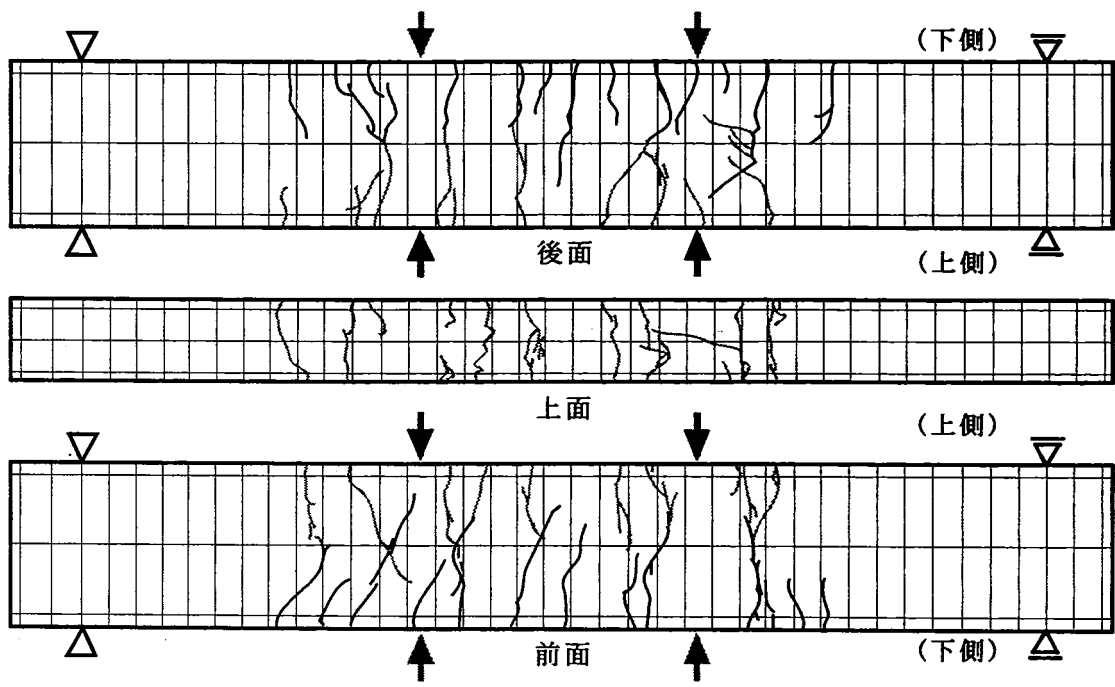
c) ひび割れ性状 [BS-2 ; R = 1/400rad.]
